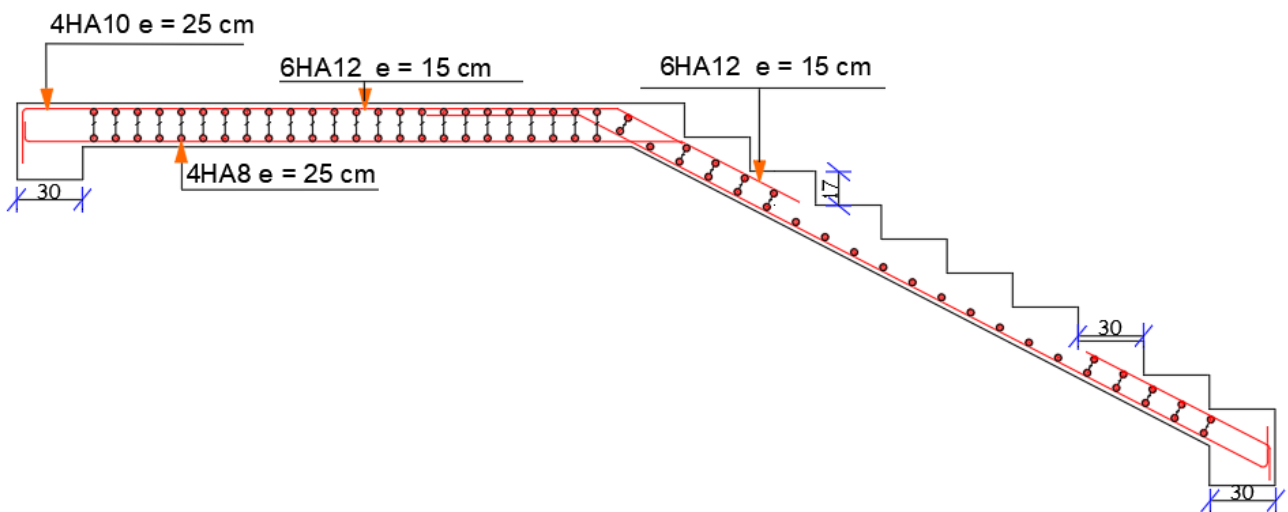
Schéma de ferrailage de l'escalier type 1.
